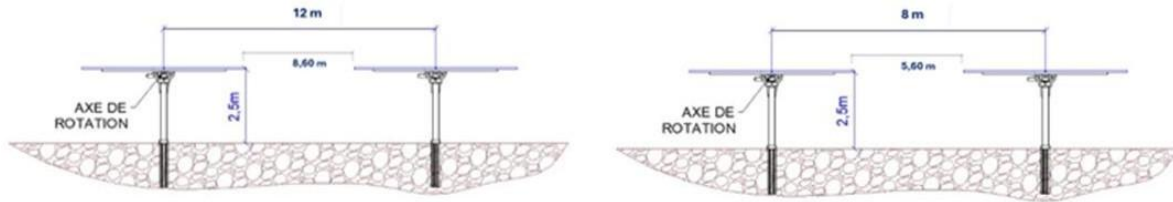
Schéma des dimensions des tables – Vue en coupe (Source : Qair)
